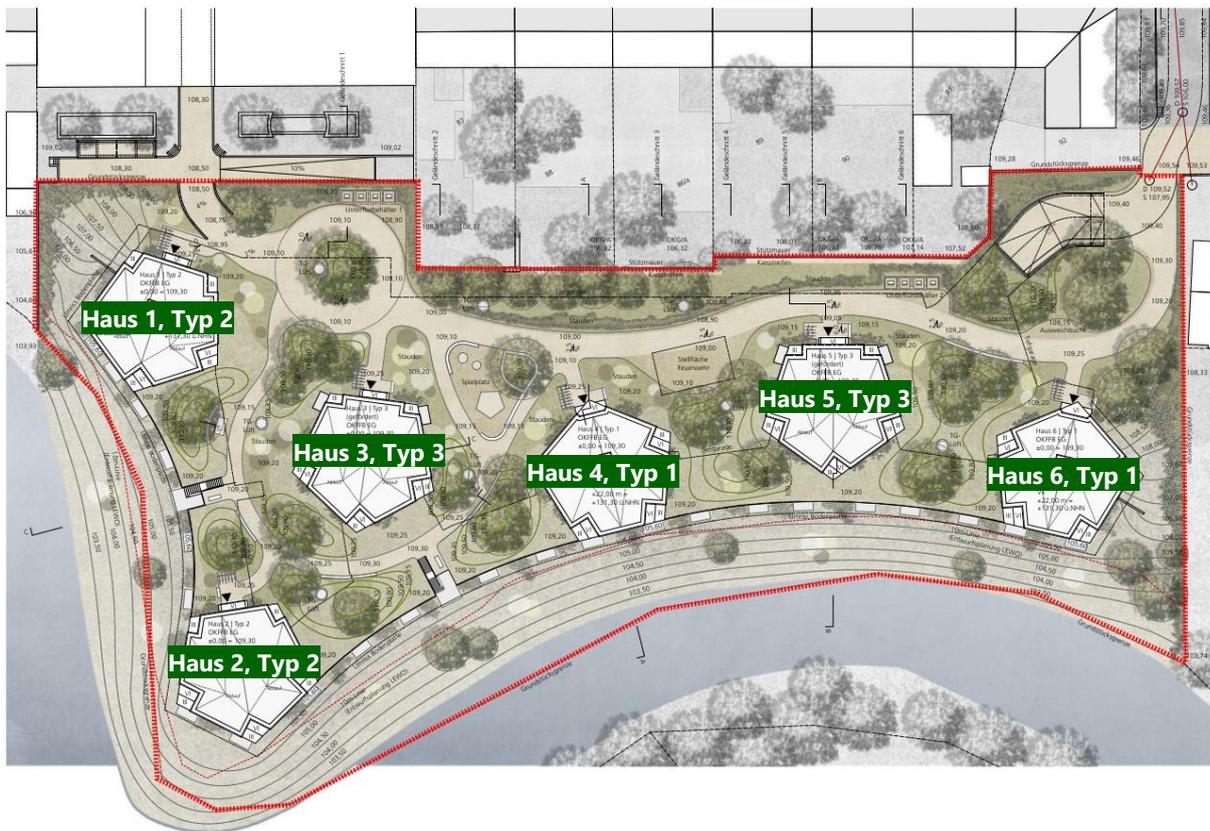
Städtebaulicher Entwurf und Geltungsbereich (rot gestrichelte Linie) für das Plangebiet und Nummerierung der Wohnhäuser und deren Grundrisstypen. Quelle: Springer Architekten.
